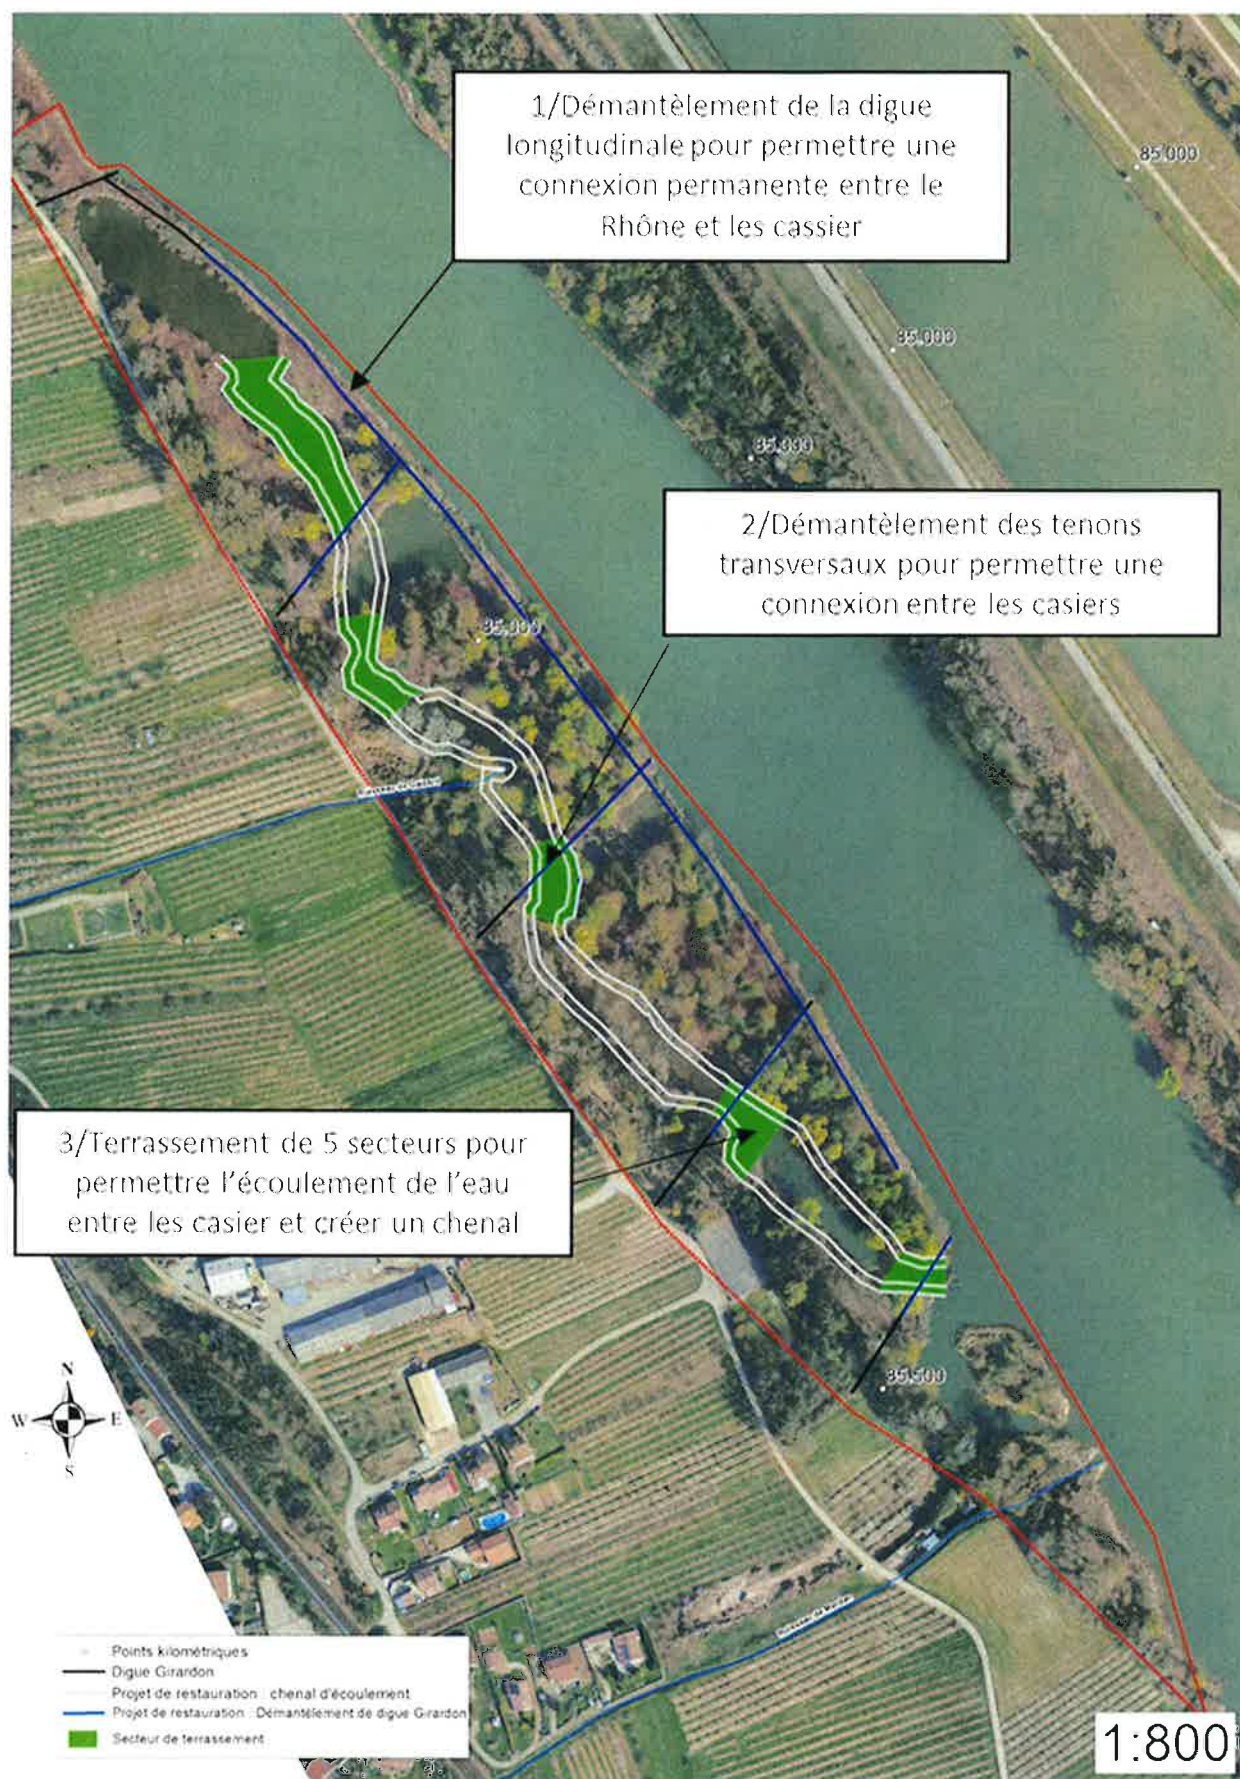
Vue en plan du projet de restauration sur le secteur de Vion
